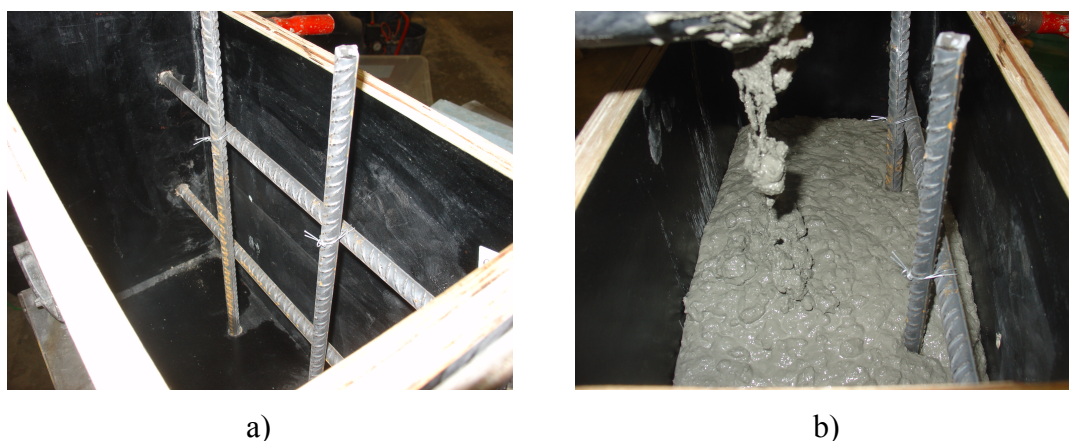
Pormenores das armaduras do Lajeta B a); fase de enchimento b).
